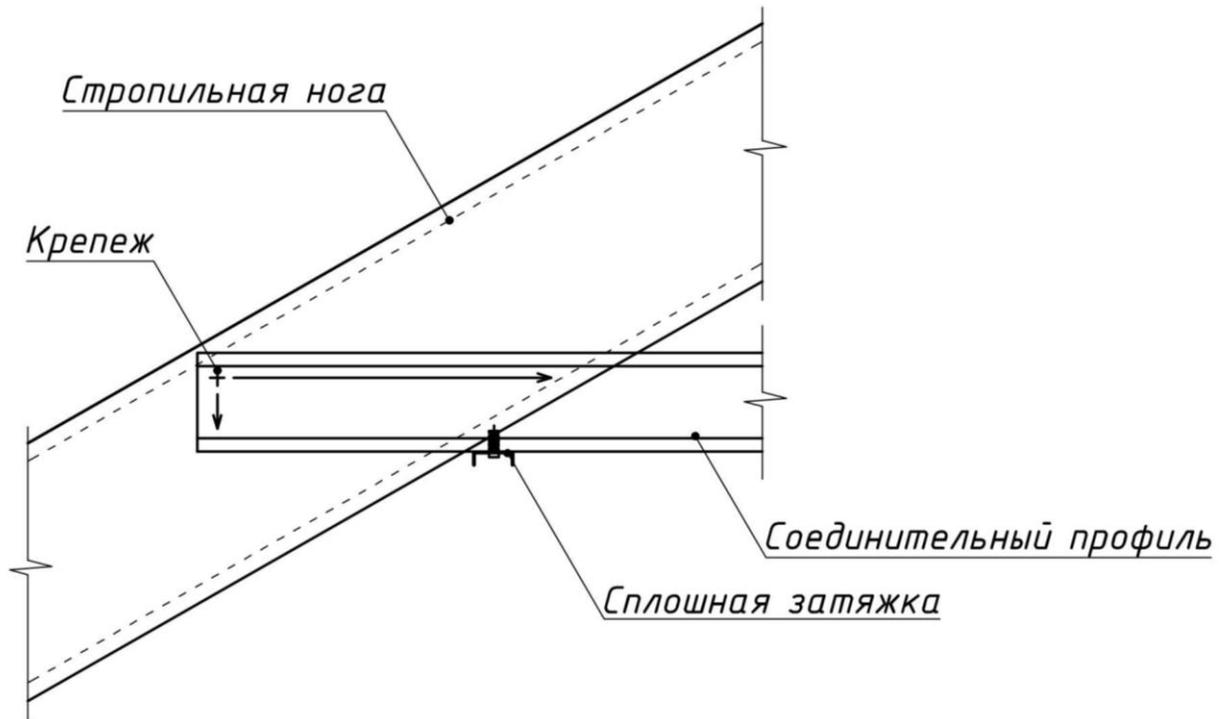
Узел К 9. Крепление соединительного профиля к стропильной ноге
